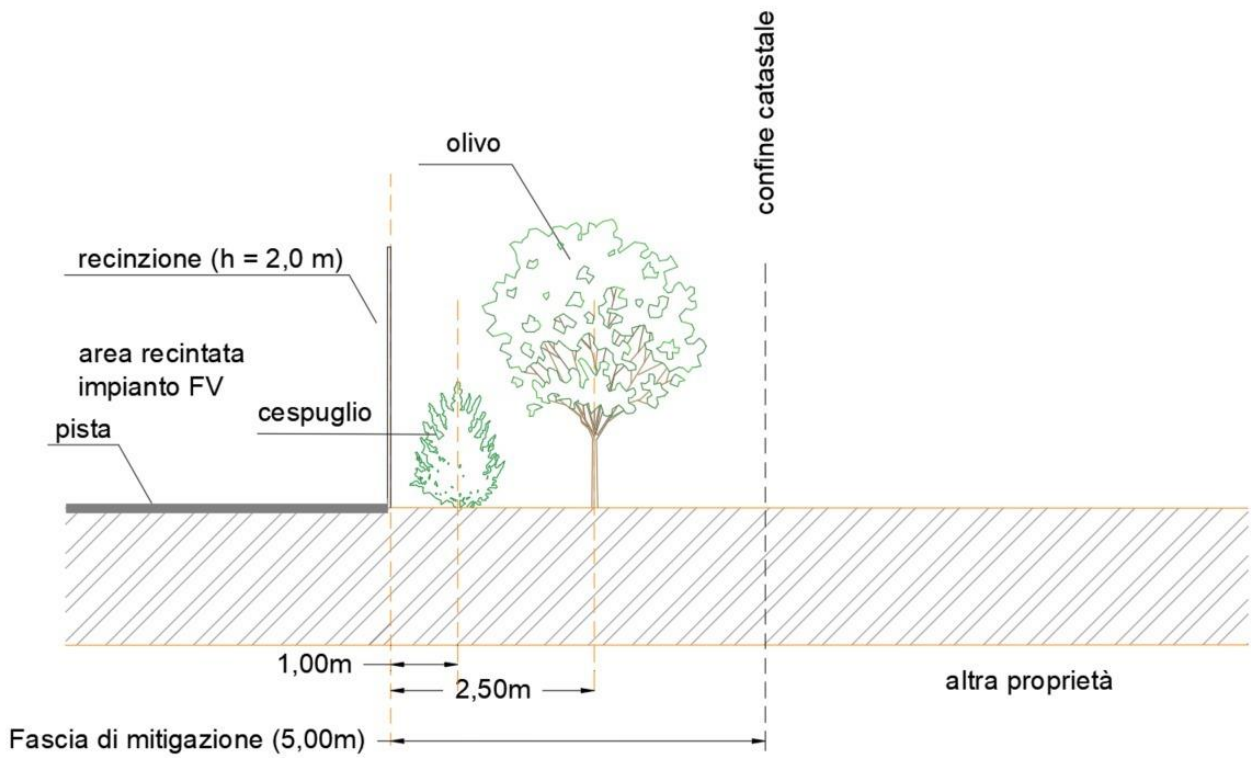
Stralcio di sezione dell'area perimetrale dell'impianto.
